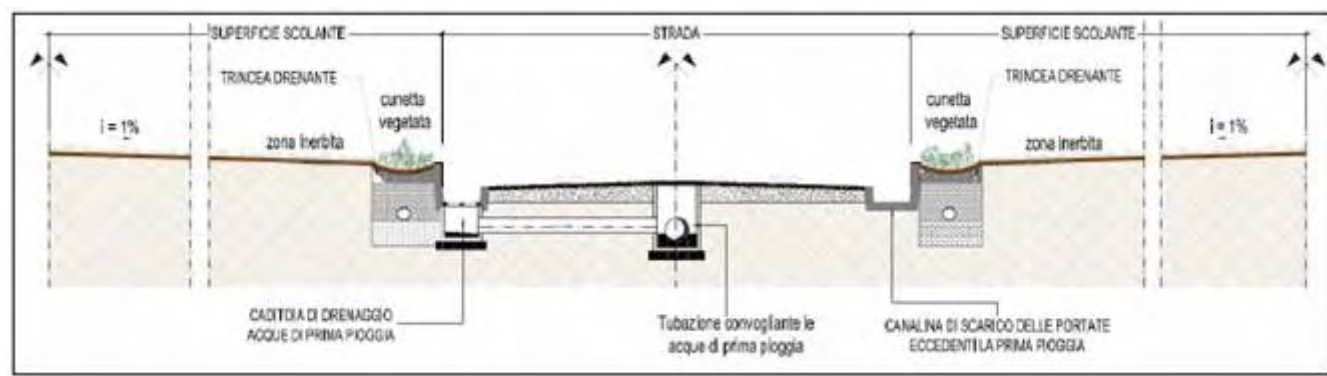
Schema della rete di drenaggio interno del sito espositivo.
